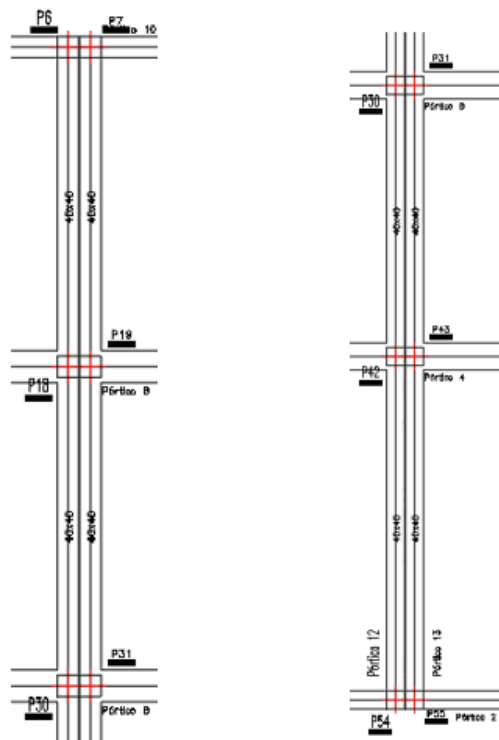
Pormenor do Pórtico 12 (Segmentado) – Pilar 54 a P6
